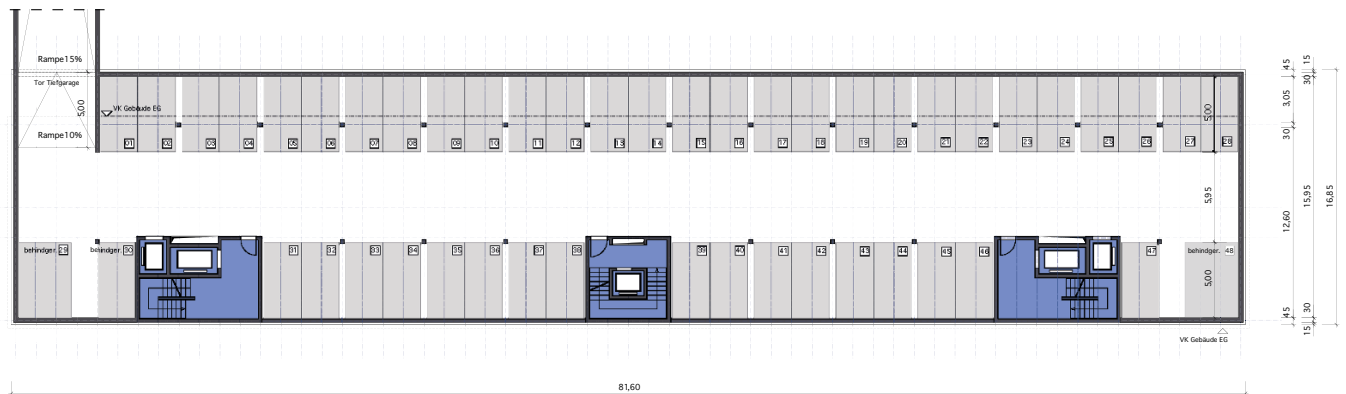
Grundrisse Referenzgebäude „hohe Variabilität“ für eine Hotelnutzung
